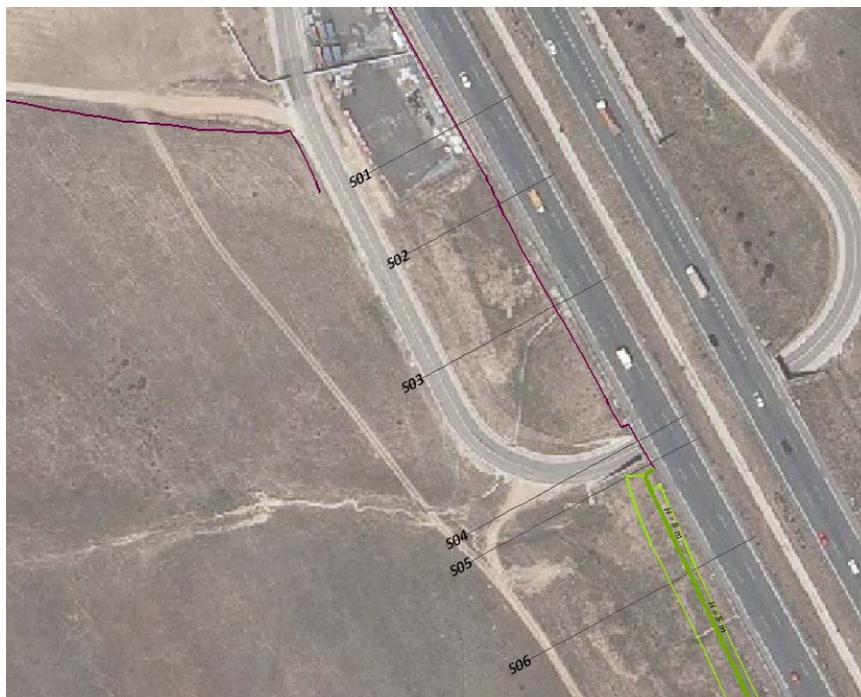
Ubicación en planta de las secciones consideradas en la zona norte del sector.
